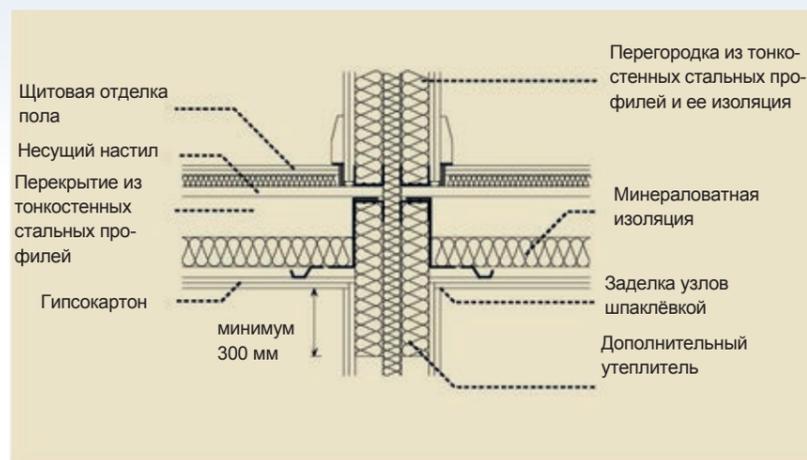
Узел перекрытия из тонкостенных стальных профилей в месте соединения с перегородкой
